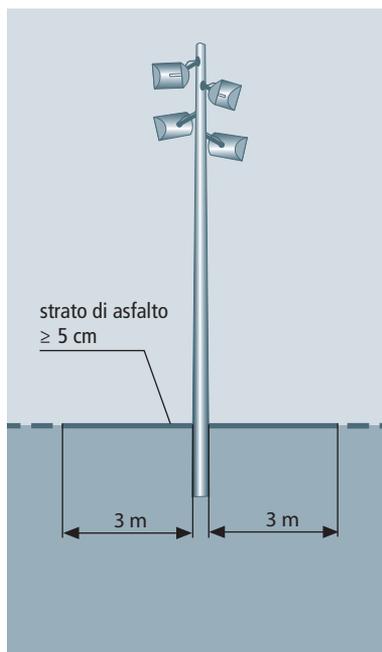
Isolamento del suolo per la riduzione delle tensioni di contatto derivanti da fulminazioni su un palo di illuminazione
